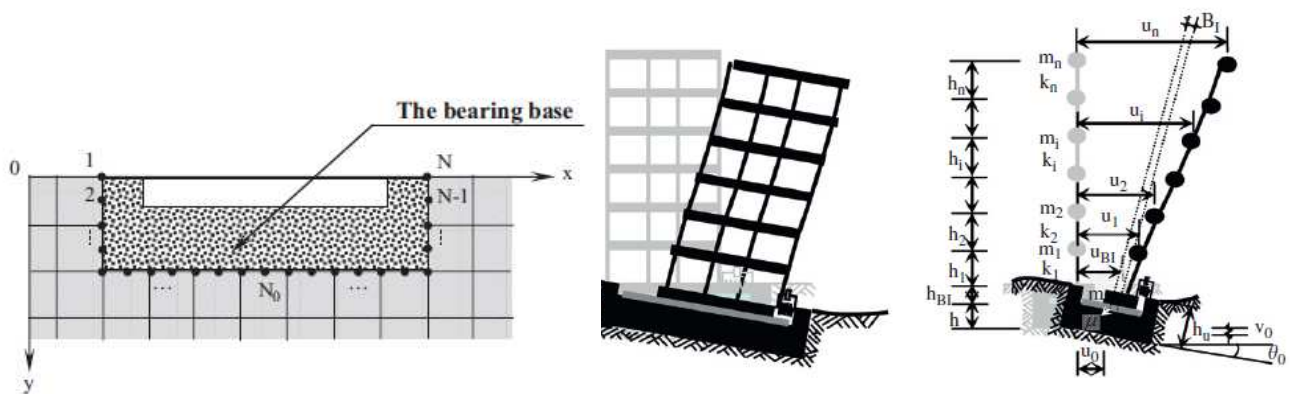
Esquema que muestra por un lado el detalle de las cimentaciones y de la base soporte y por otro lado el desplazamiento que se quiere calcular de cada planta cuando actué la explosión [12].
